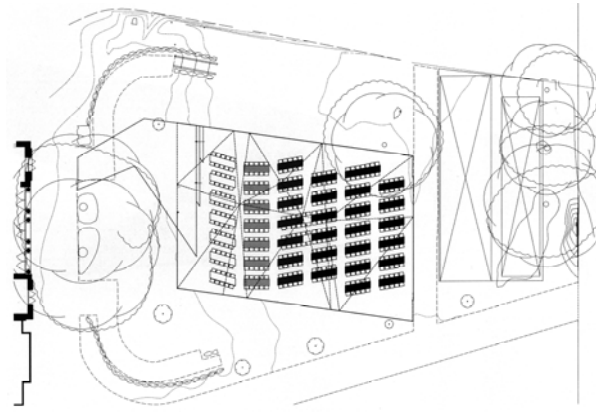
Planta, pavilhão de Zaha Hadid, 2000.
